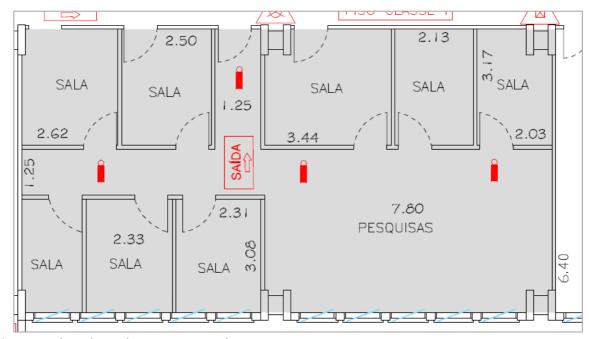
Planta baixa do Departamento de Pesquisa. FACERES, 2023.
